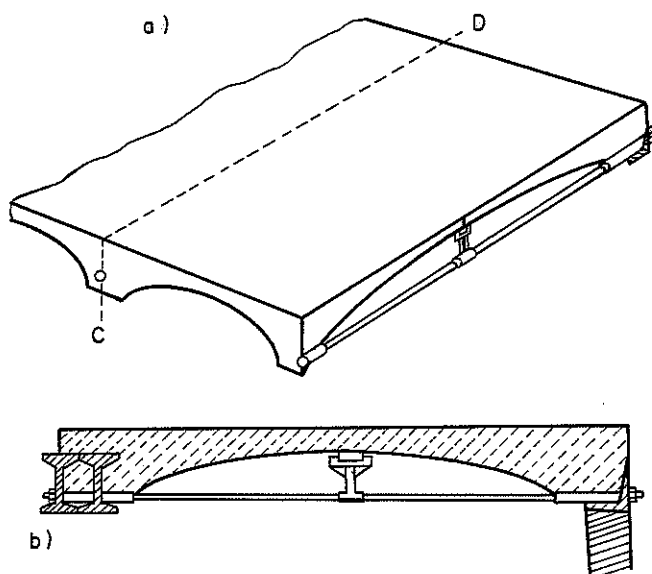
ABÓBADA COM BARRAS DE AÇO COLOCADAS NA DIREÇÃO LONGITUDINAL
